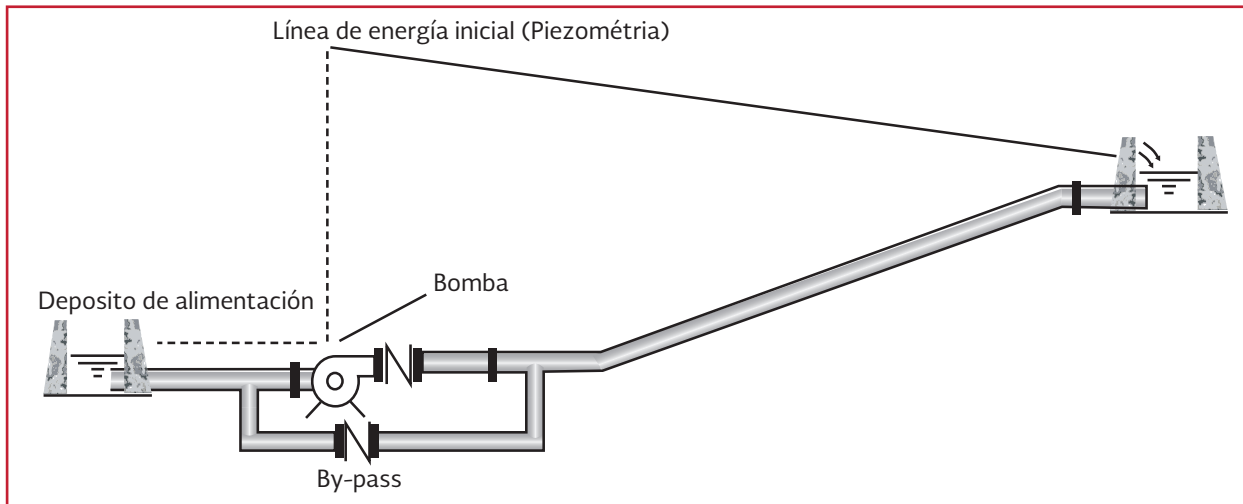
Paso lateral (bypass) en una planta de bombeo
